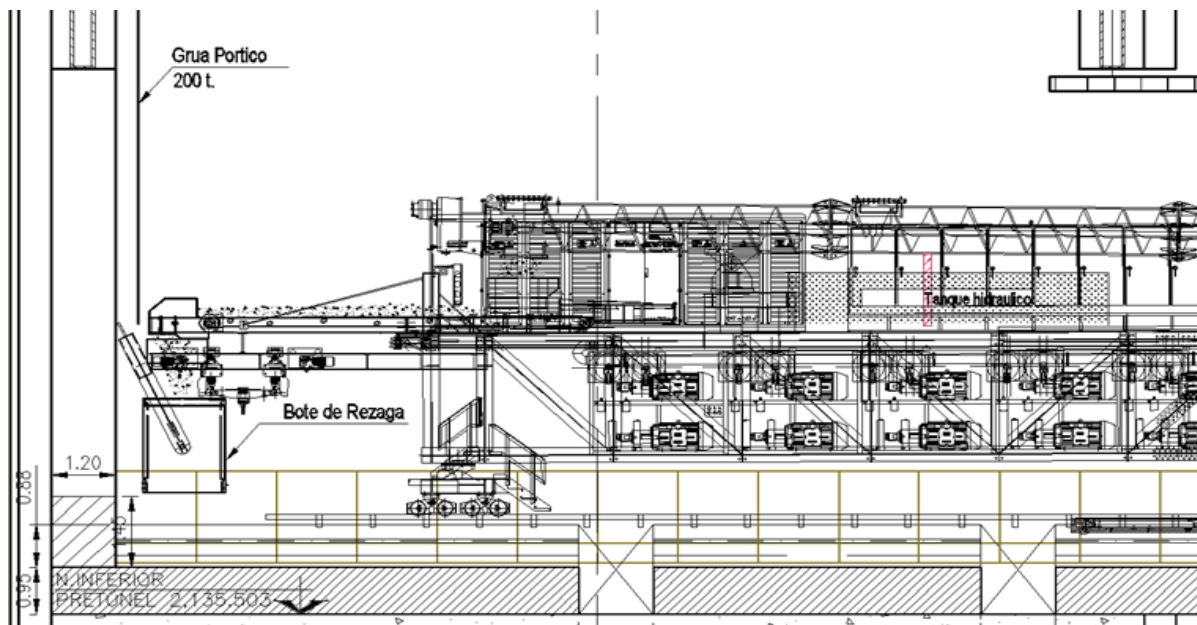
Ubicación del bote de rezaga para extracción de material excavado.
